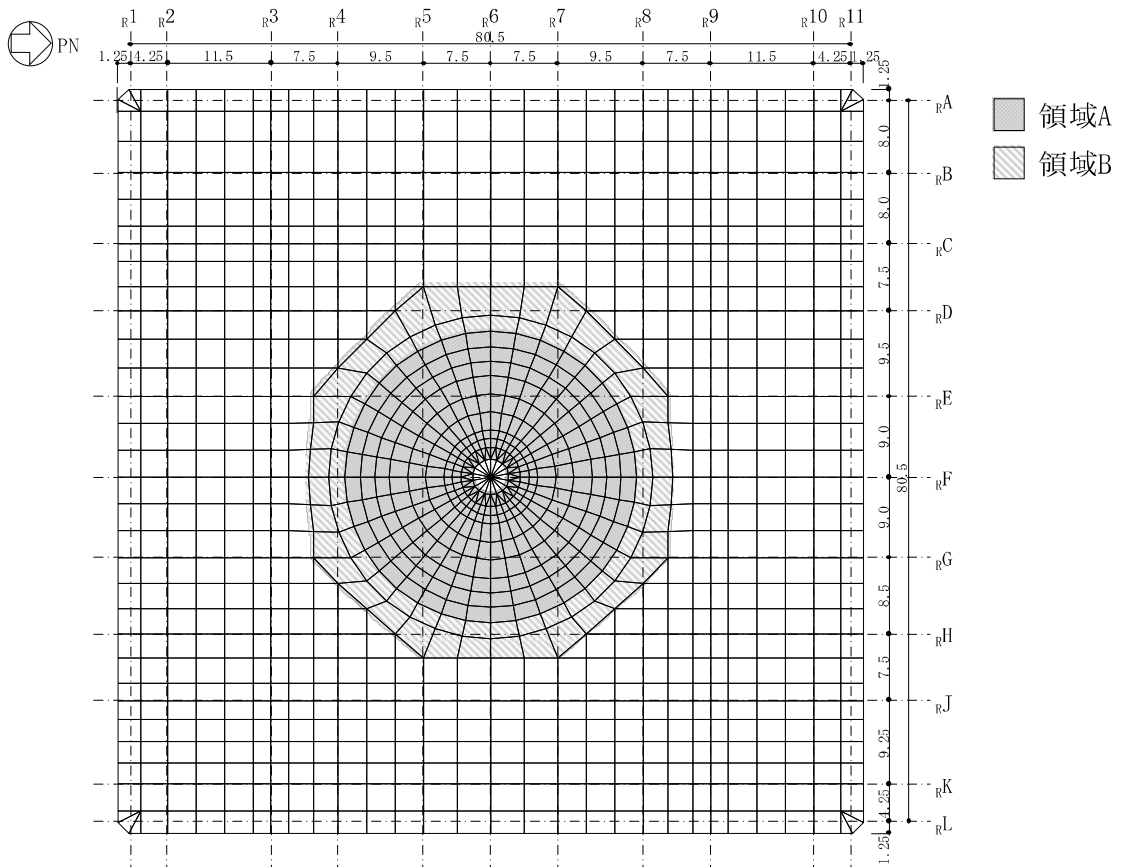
基礎スラブの配筋領域図（円周方向，上ば筋）
